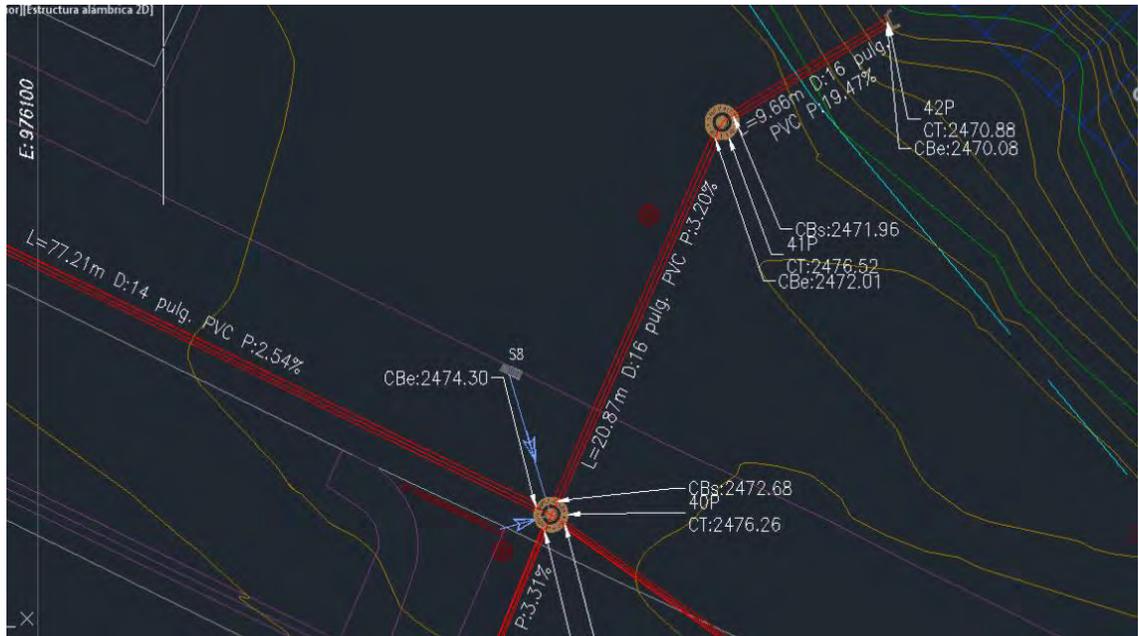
Diseño alcantarillado pluvial tramo 40P a 41P; 41P a Descarga
